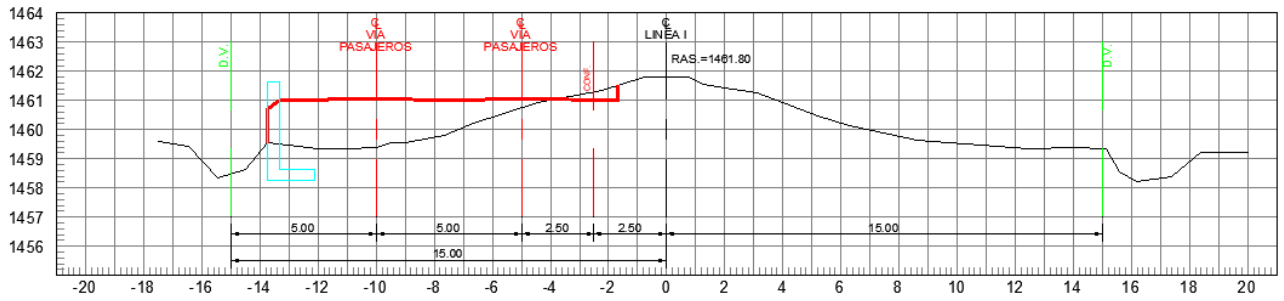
Perfiles tipo en secciones de la Línea 4 del Tren Ligero a cada kilómetro de distancia
